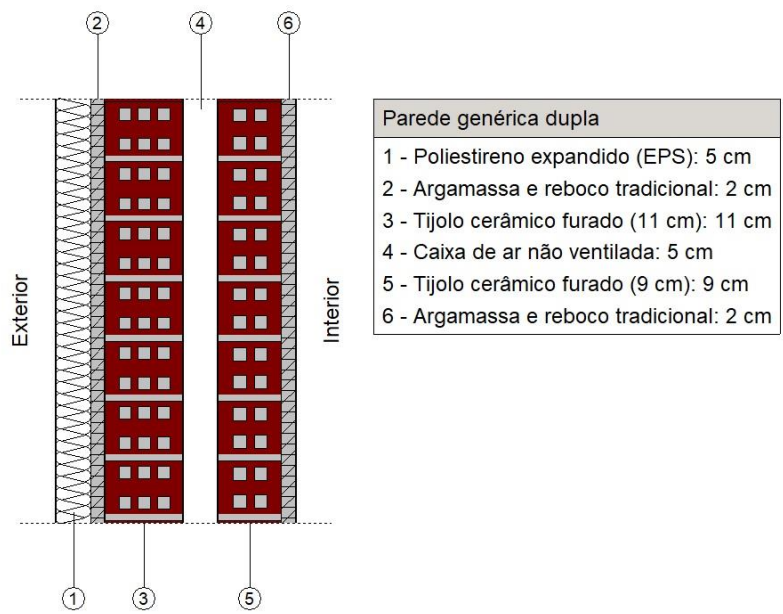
Pormenor construtivo da zona corrente, numa situação tipo de melhoria
